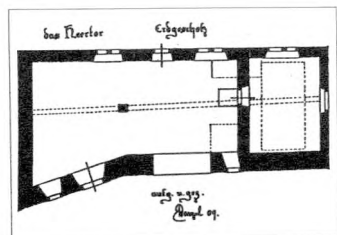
Das Heertor – Grundriss Erdgeschoss.
